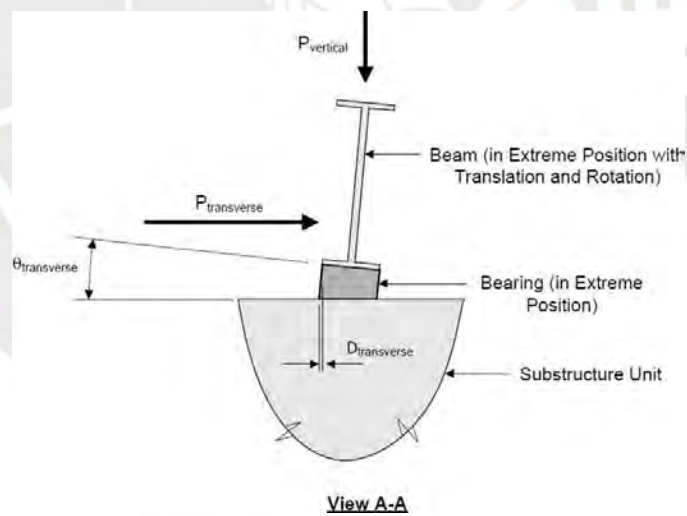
Corte A-A del aislador elastomérico en la que se aprecia el efecto de traslación y rotación del aislador y la viga del puente debido a las cargas verticales y horizontales.
